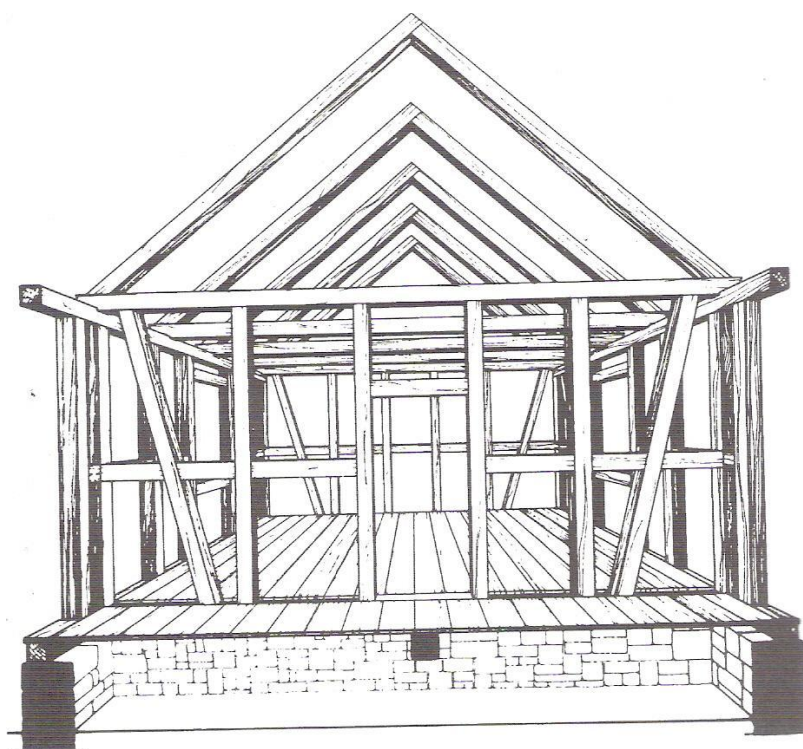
perspectiva da fundação de pedra e da estrutura em madeira presentes em toda construção de Enxaimel (WEIMER, 2005, p. 212)
